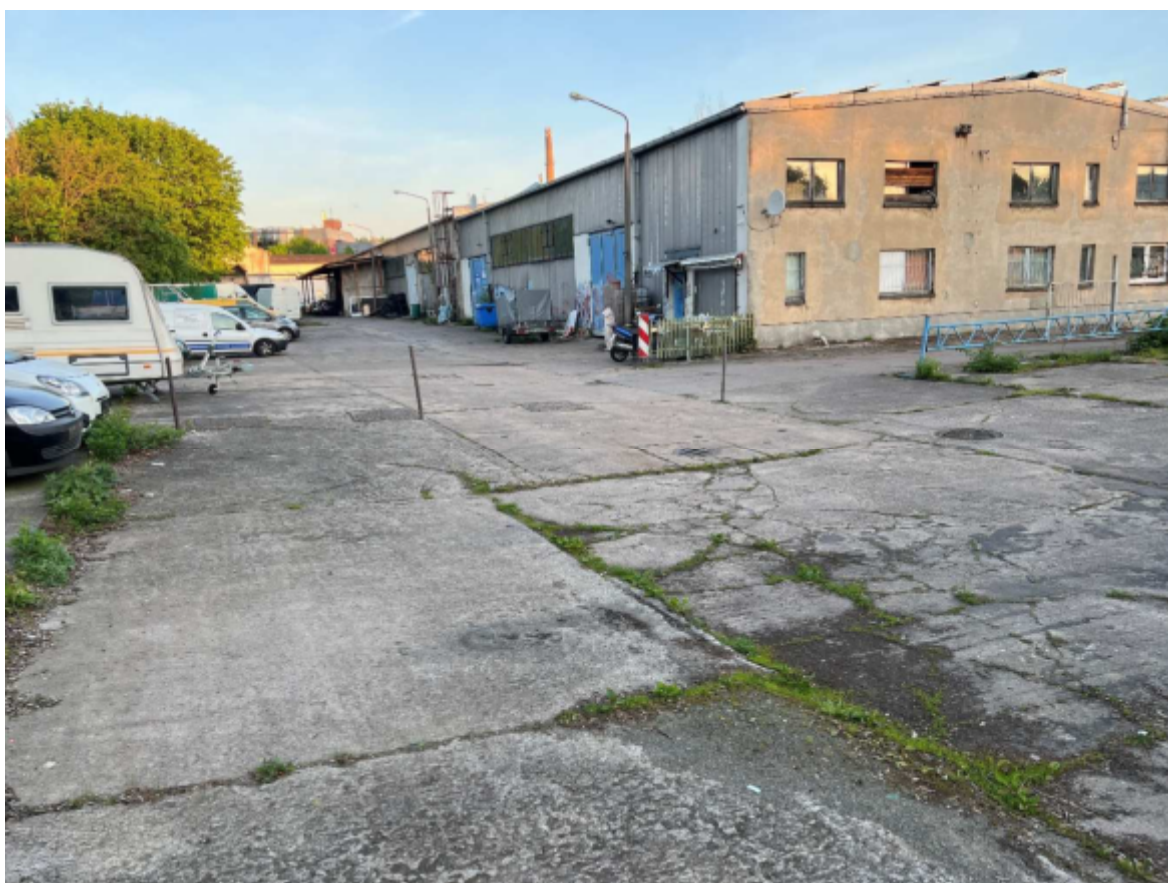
vorhandene Gebäude im südlichen Planbereich mit angrenzendem Gehölz
